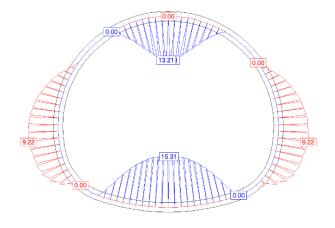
Secção TV.2. Armaduras de cálculo de flexão (cm²/m)
